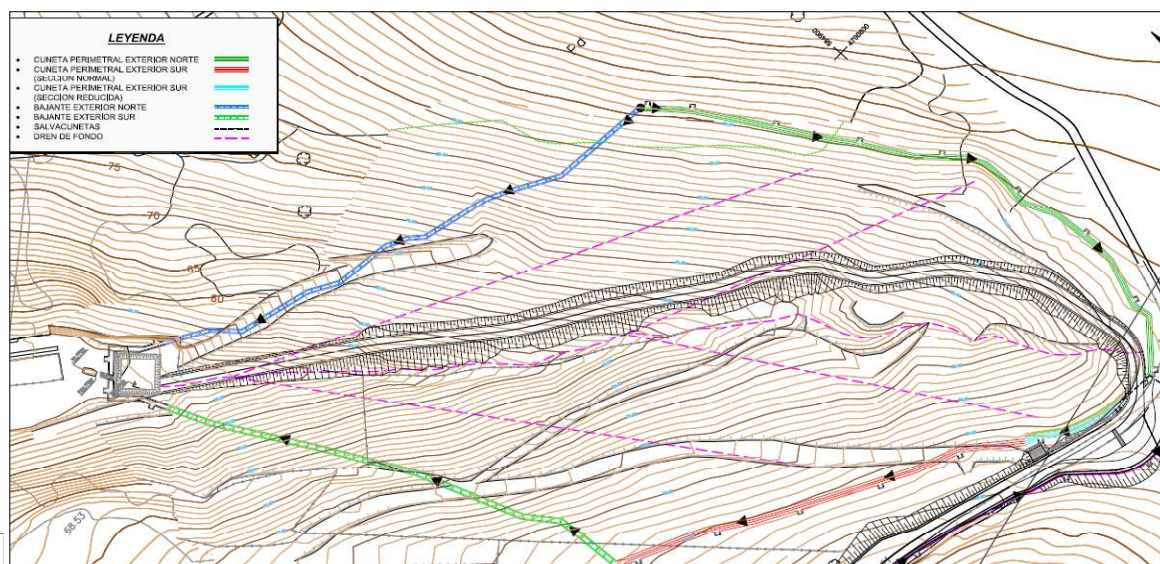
Plano del proyecto constructivo del relleno. Fuente: SENER 2011.
